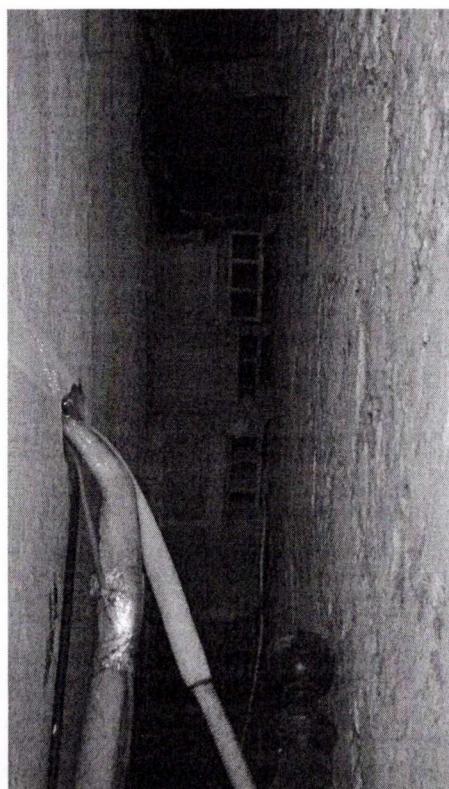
MURO UBICADO EN LA CAMARA DE AIRE EN EL ÁREA DE ALCOBAS DE LA VIVIENDA COLINDANTE Y CONEXIONES DE AIRE ACONDICIONADO
